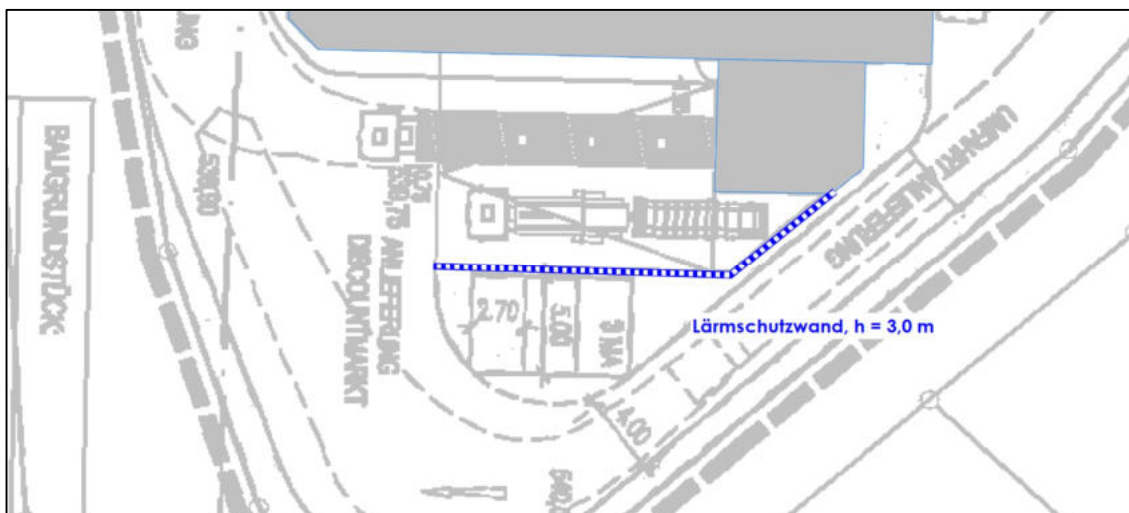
Lageplan /18, 31/ mit Eintragung der Lärmschutzwand
